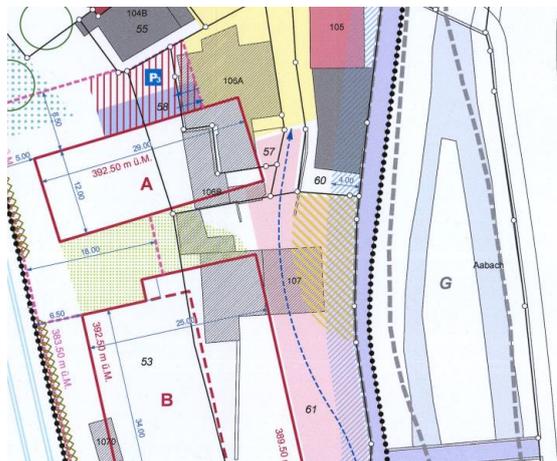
Ausschnitt Gestaltungsplan „Brunnrain“, 20.09.2021
